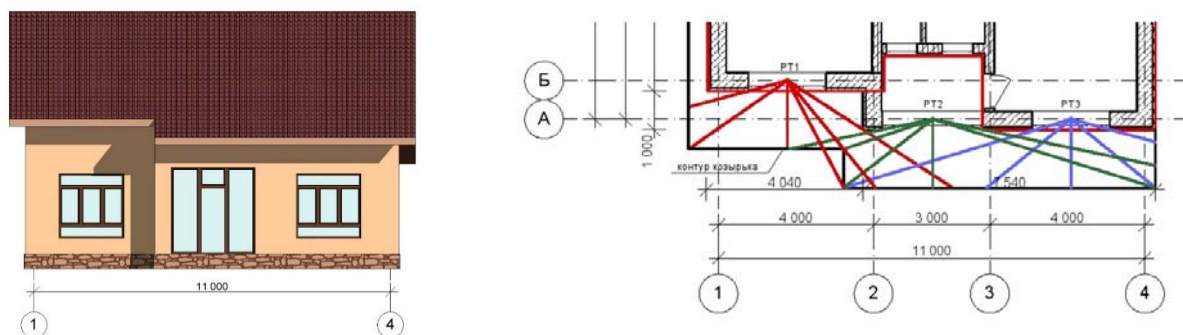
Южный фасад энергоэффективного дома и фрагмент плана 1-го этажа
